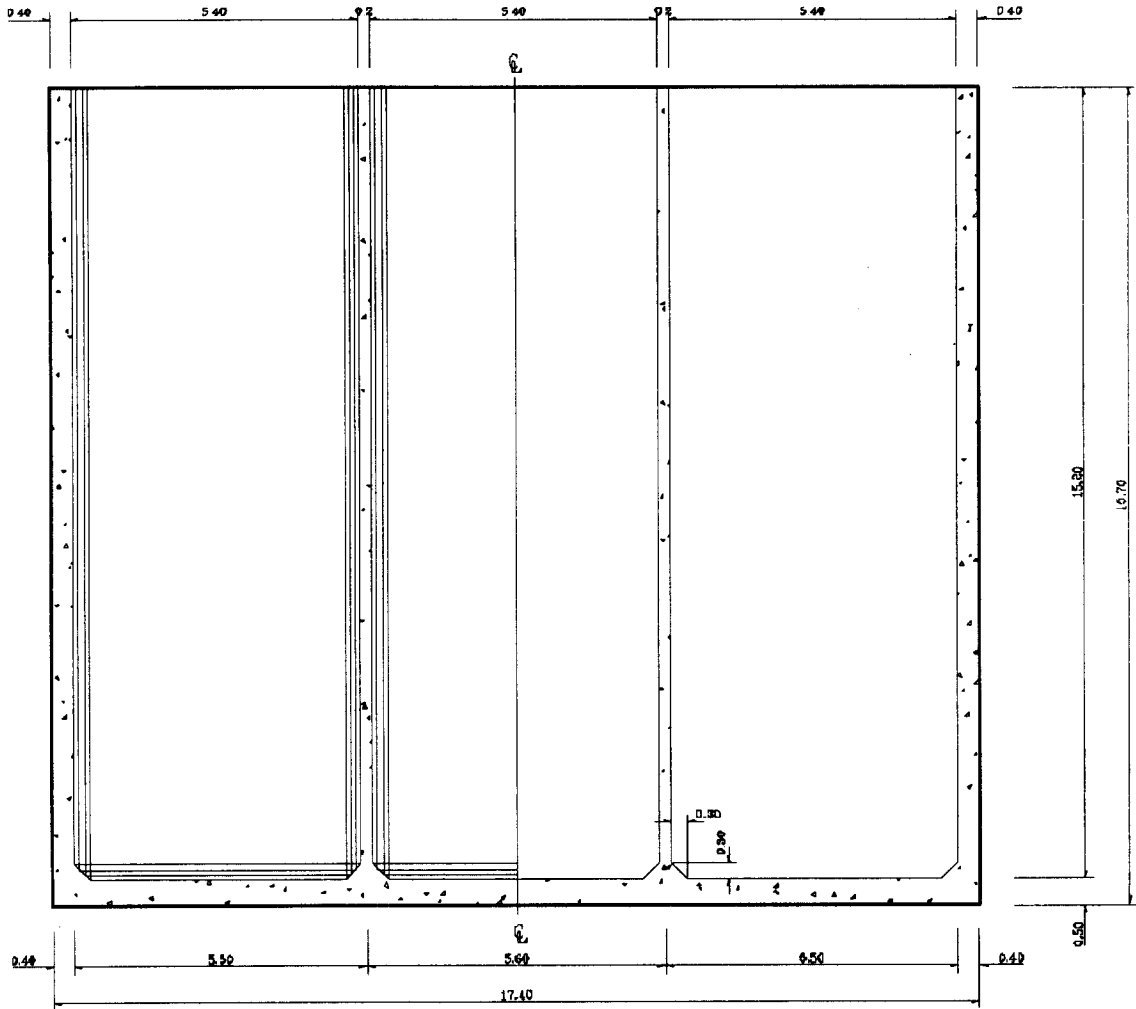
대상 케이슨의 단면도 (단위 : m)
